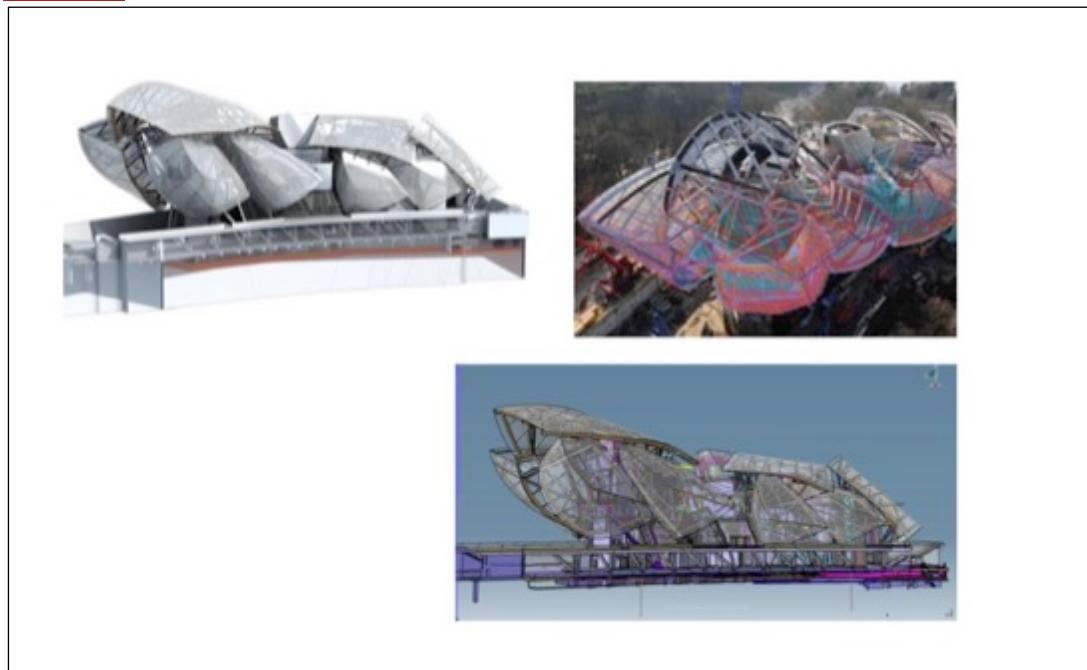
Vues 3D de la Fondation Louis Vuitton
